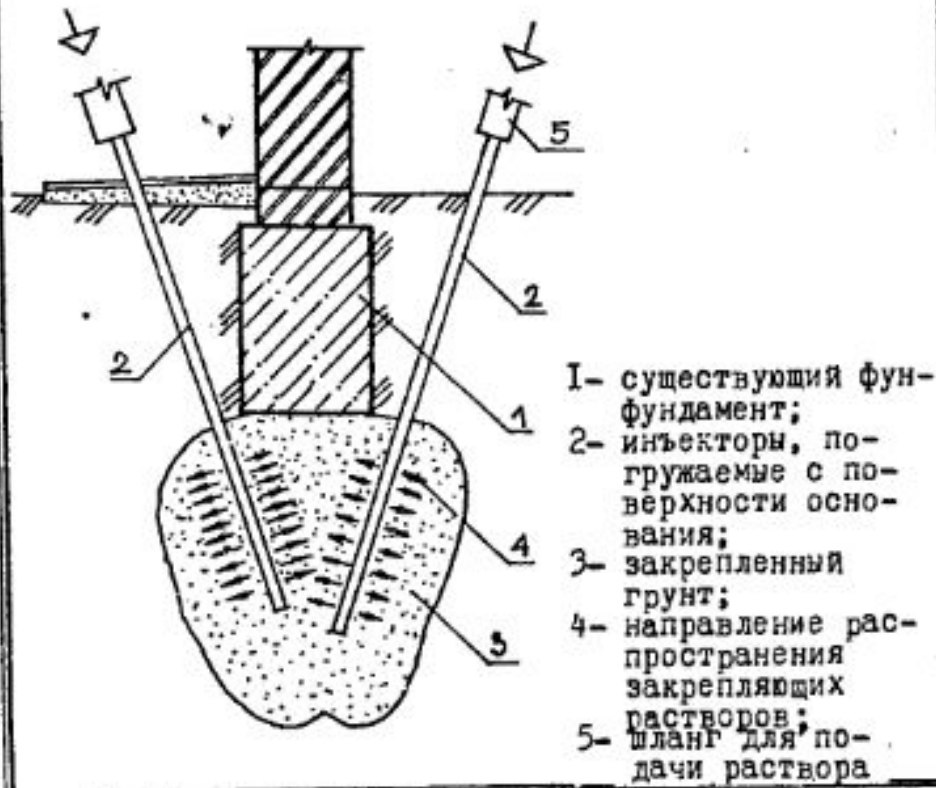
Разрез по укрепленному грунту под фундаментами
